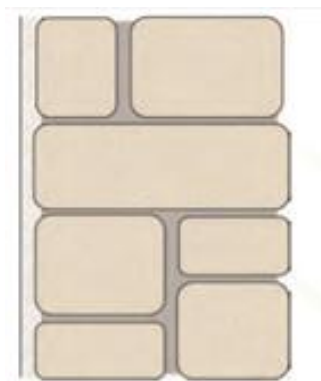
Parede exterior em pedra da casa do Porto burguês. [8]
